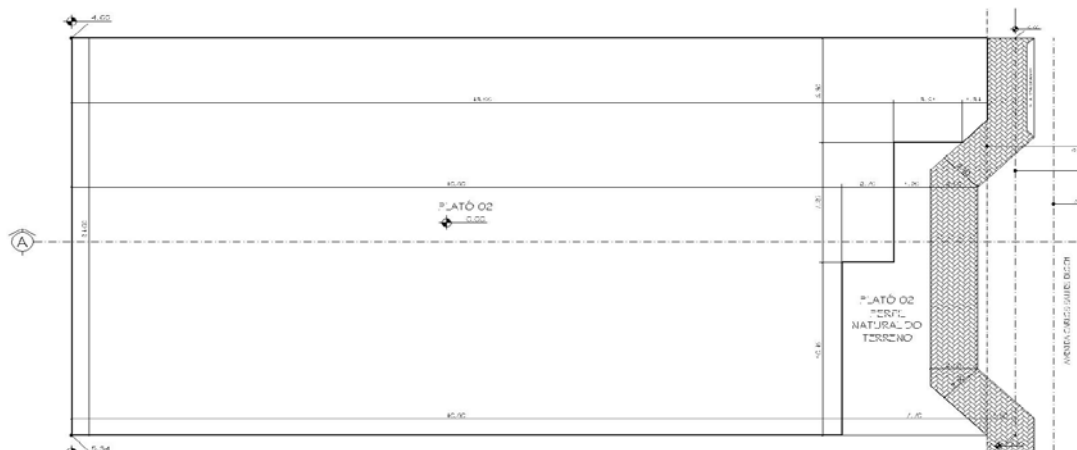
Projeto de Terraplenagem (ANEXO 03)
